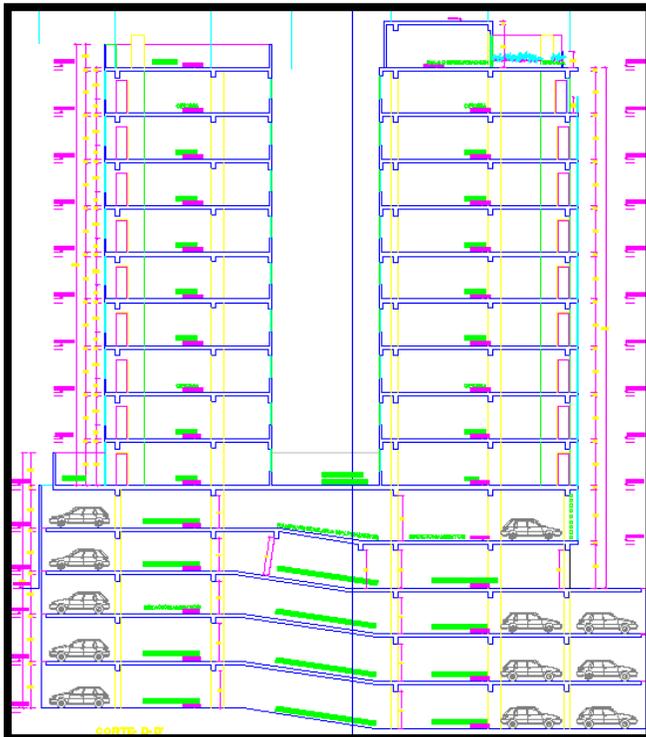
Corte D-D' - Longitudinal a Edificio Monte Rosa
